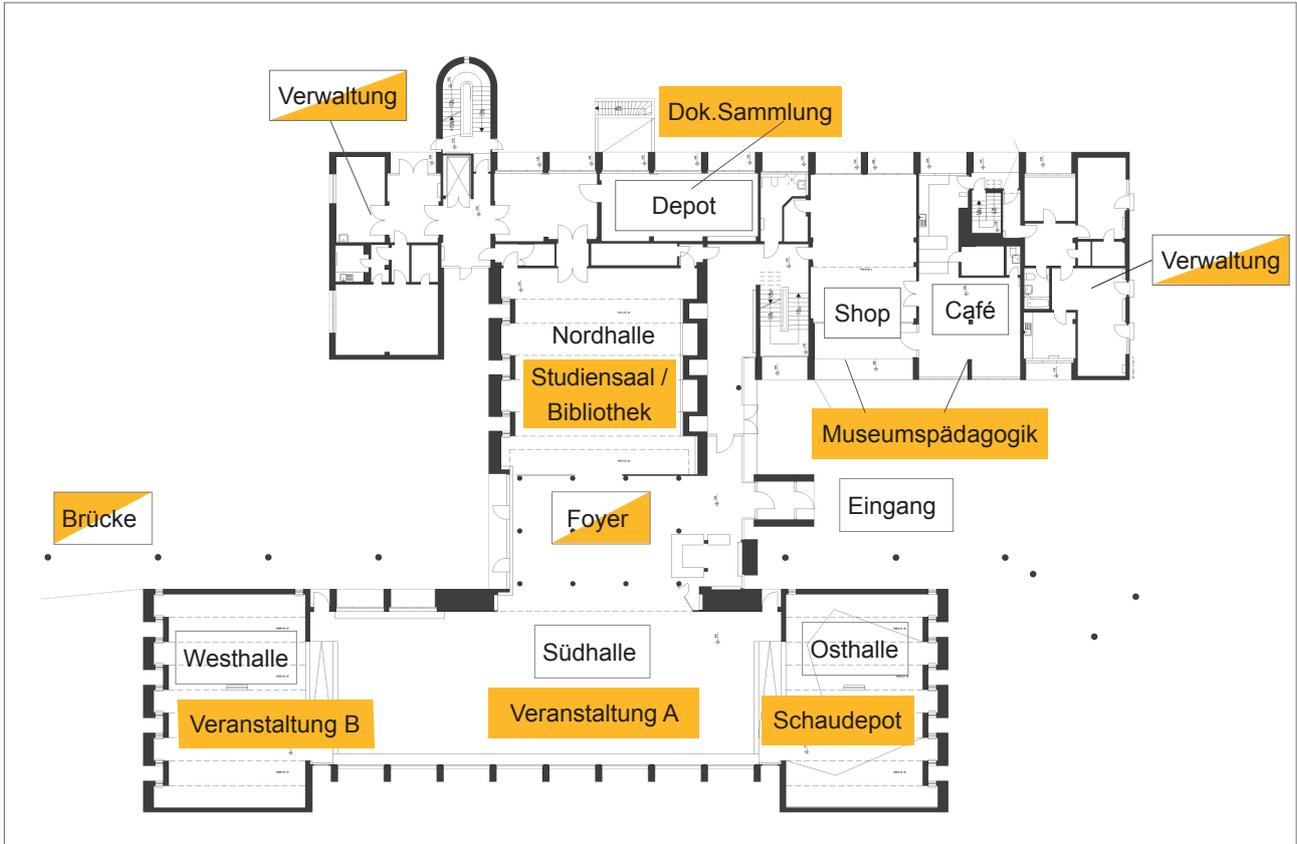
Grundriss EG - Bestand mit Darstellung der übergeordneten Nutzung: Bestand  und Einpassplanung
